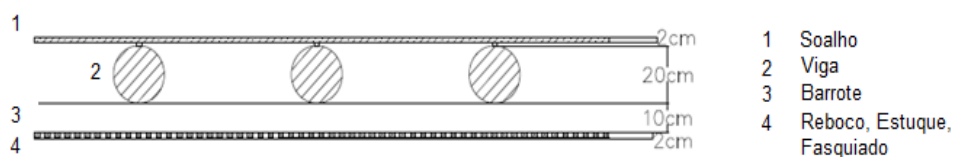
Representação real da constituição do pavimento com teto estucado
